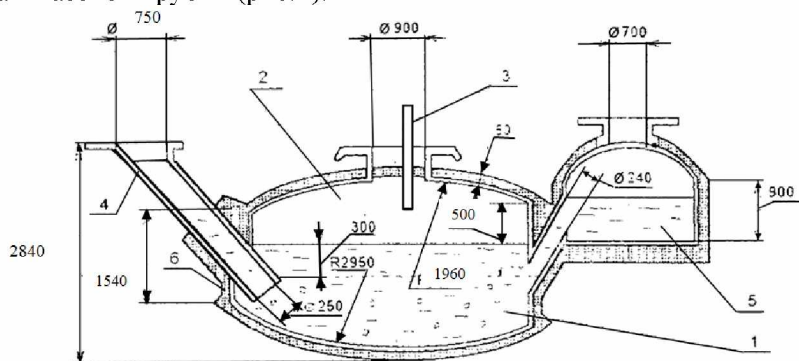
Схема биогазгенератора: 1 - ферментируемая масса, 2 - сборник газа, 3 - газовая трубка, 4 - загрузочная труба, 5 - резервуар для создания гидравлического давления, 6- основной резервуар.
